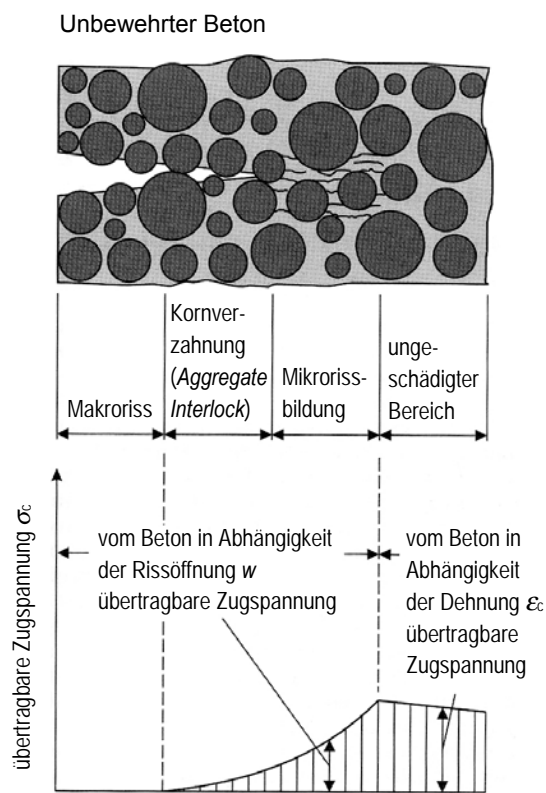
Übergang von der Mikro- zur Makrorissbildung bei unbewehrtem Beton [Hol06]
